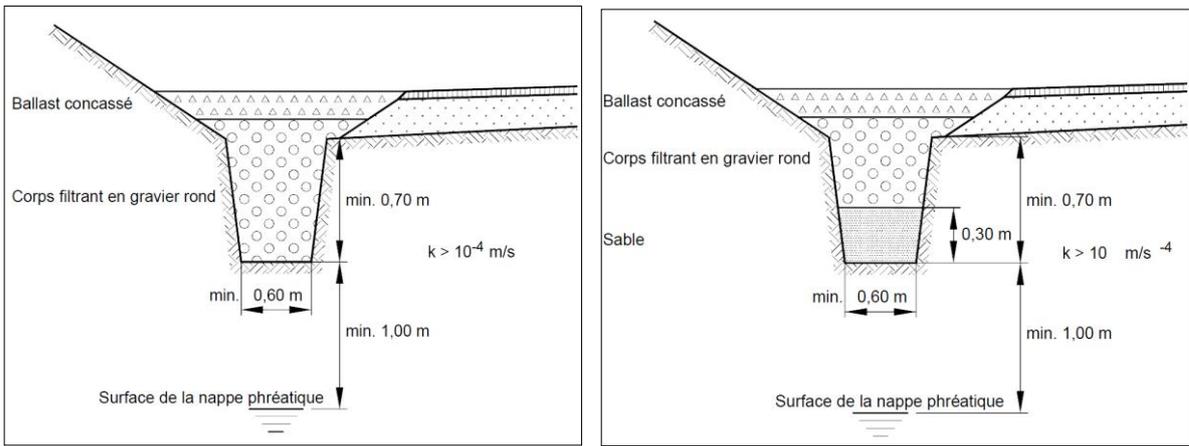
Type 3a – Tranchée drainante (avec ballast ou ballast/sable)
